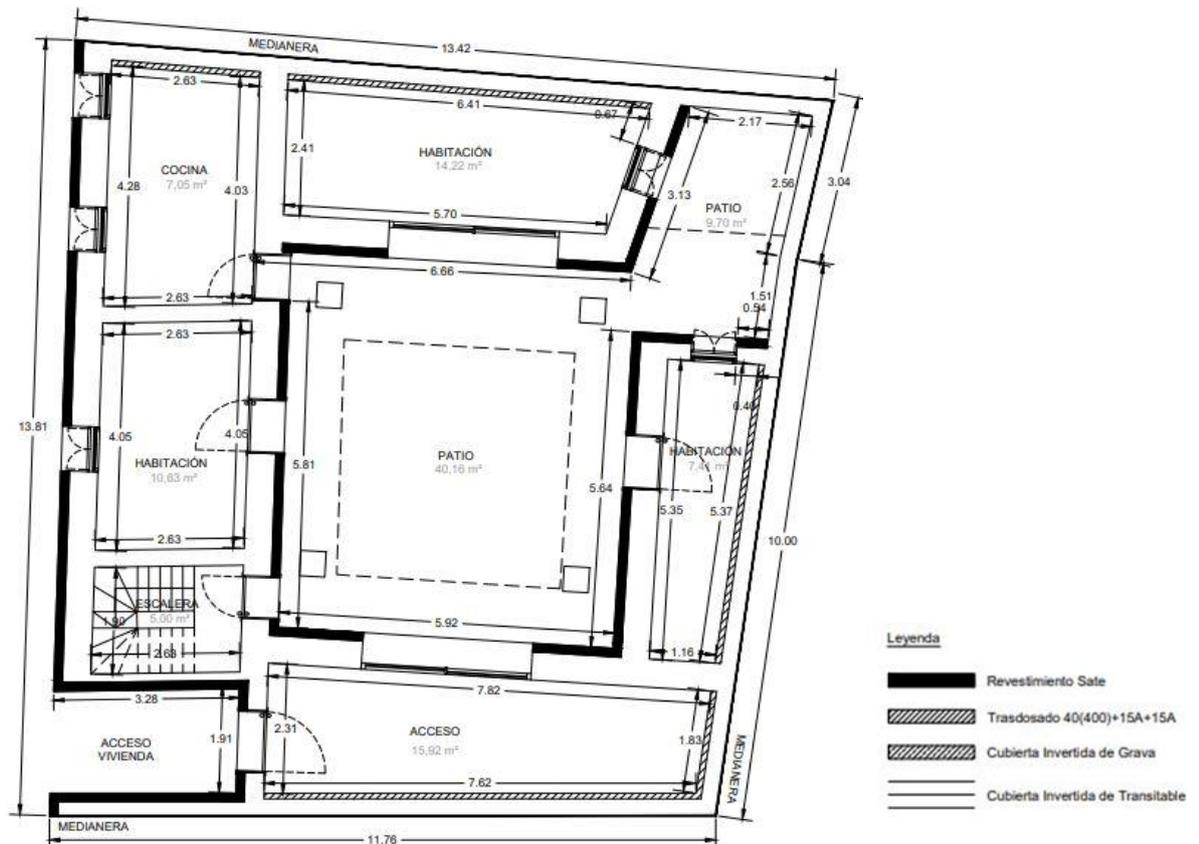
Planta baja del edificio- propuesta mejora integral. (elaboración propia)
